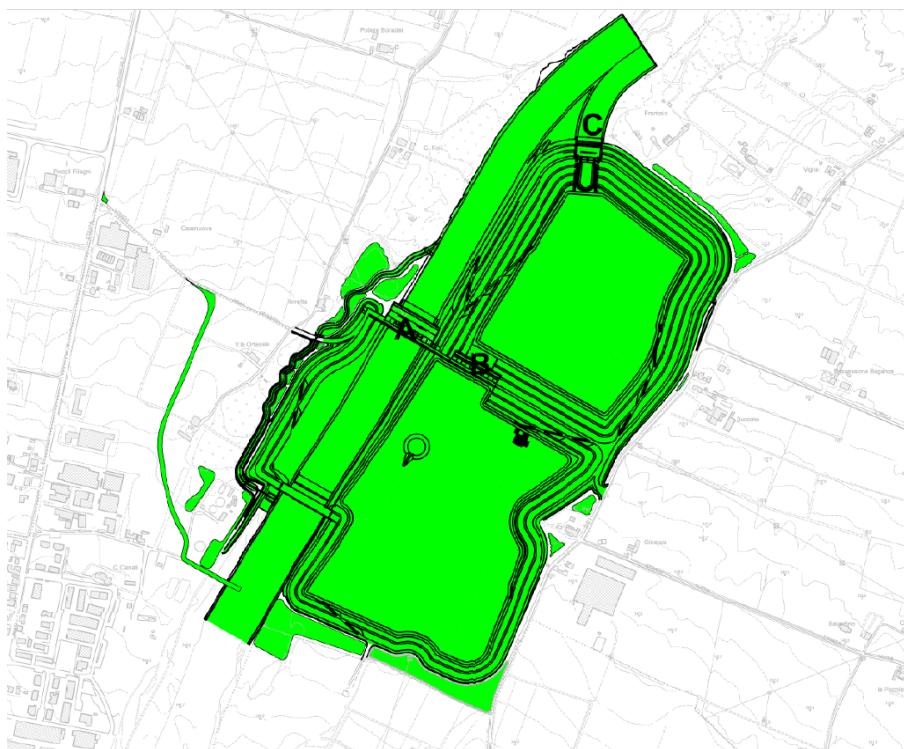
Rappresentazione planimetrica della FASE 11
